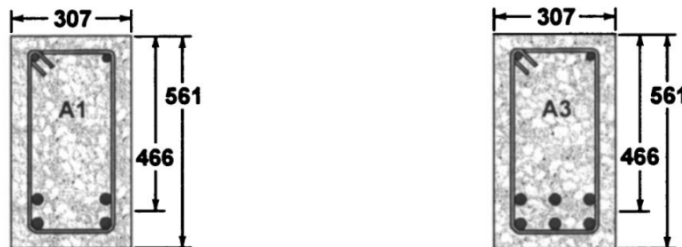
(izq.) sección transversal viga A1, (der.) sección transversal viga A3 [14]
